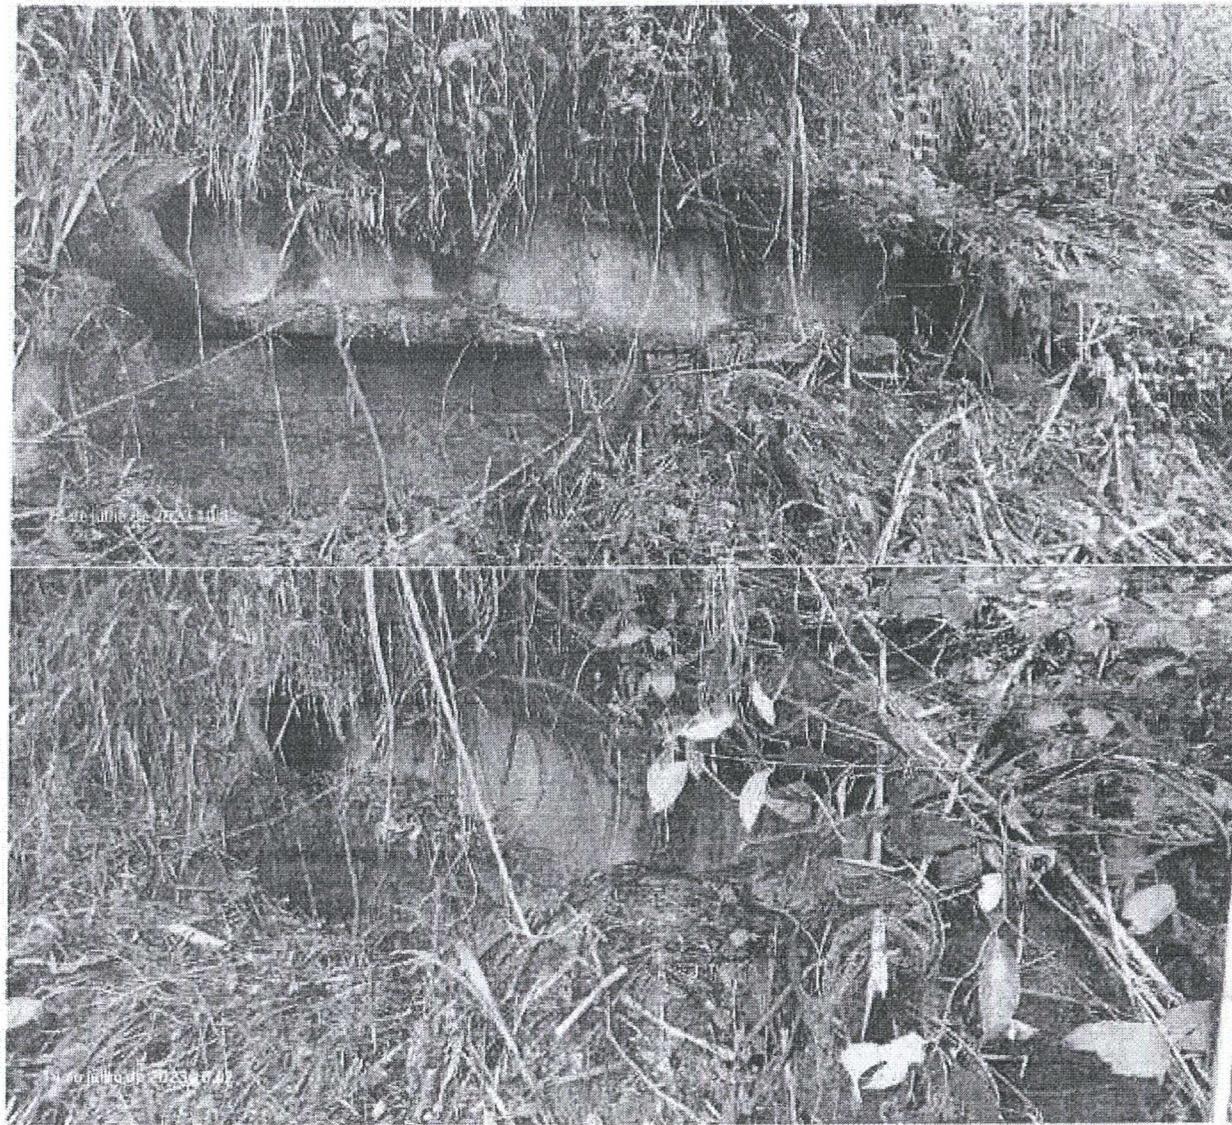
Canalização de esgotamento sanitário em manilhas de concreto transpõe em alinhamento transversal o terreno, posicionado em talude de corte de aterro escavado para empréstimo de terra, operação que, provavelmente, provocou a avaria na rede enterrada. Imediatamente a jusante desta rede rompida, verificou-se área alagadiça no terreno, que se espalhava, aleatoriamente, por superfície relativamente plana, sob densa cobertura graminosa de capim Napier, encontrando escoamento para o poço de águas negras a jusante.
